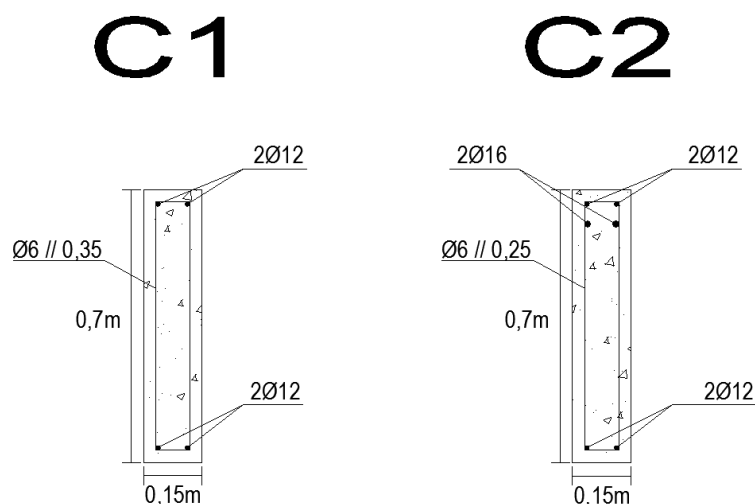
Corte transversal da viga de piso 2 do pórtico 1-1'
